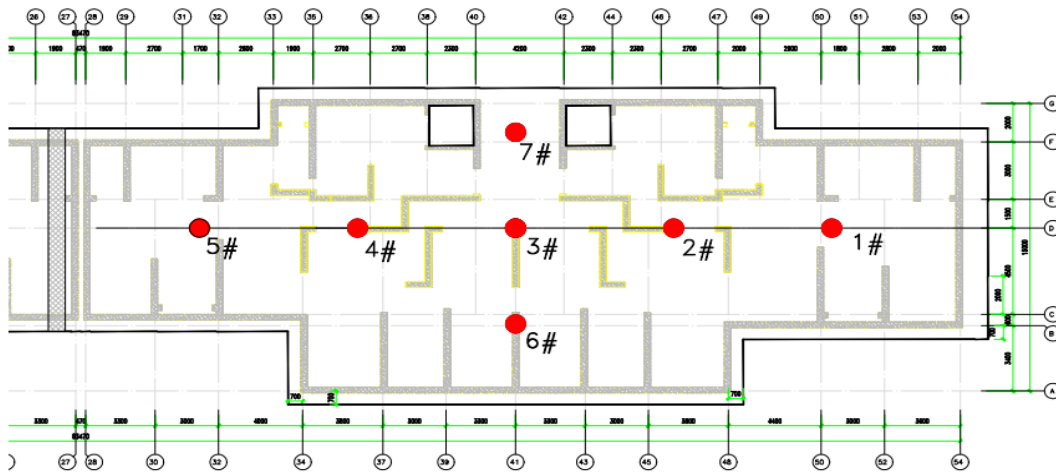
底板大体积混凝土测温点平面布置方式图
